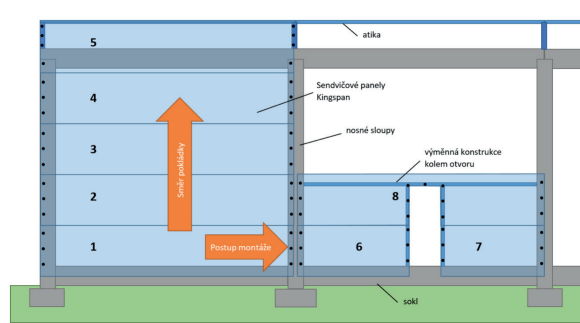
postup upevnění vertikálně kladených panelů ke konstrukci
